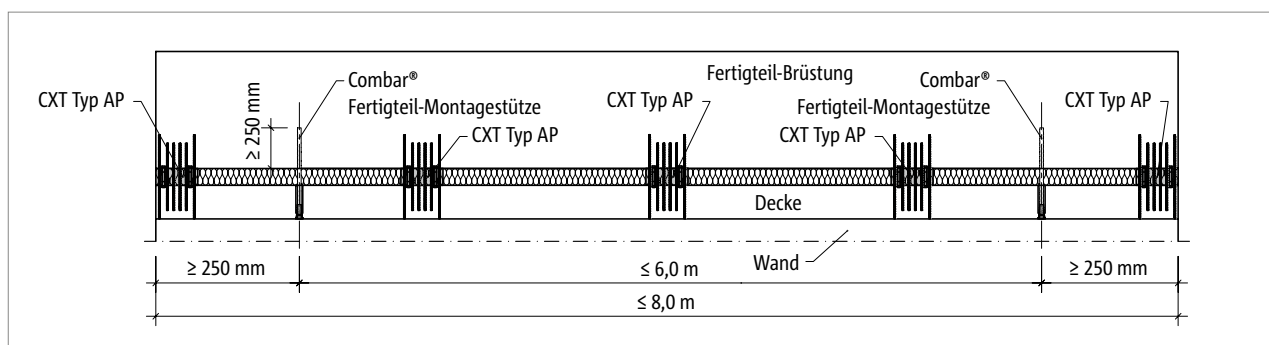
Schöck Isokorb® CXT Typ AP mit Combar® Fertigteil-Montagestütze: Randabstände und Mindesteinbindelänge in der Fertigteilbrüstung
